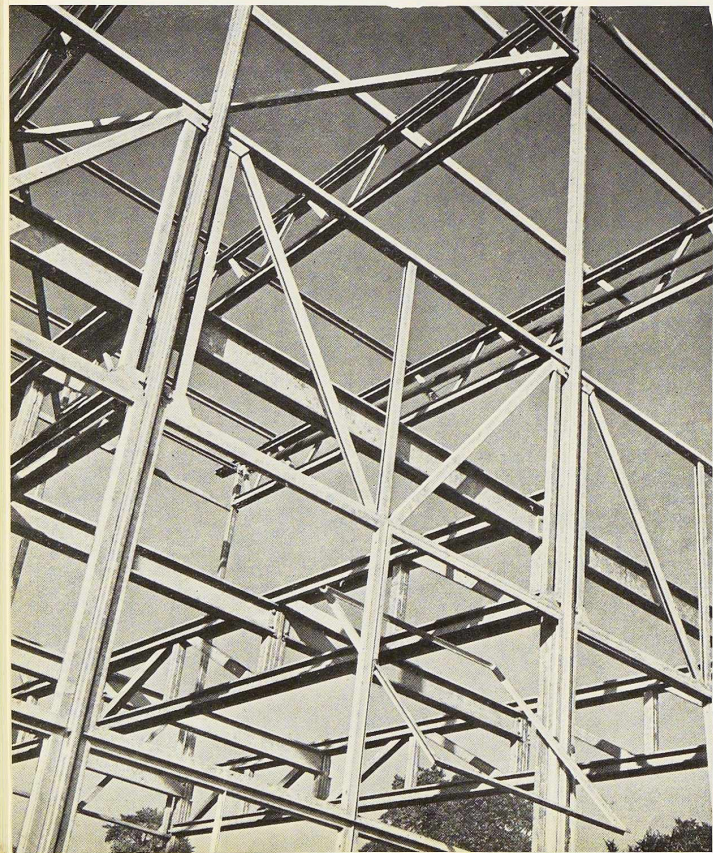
Poutre de toiture en treillis avec panes en bois.
